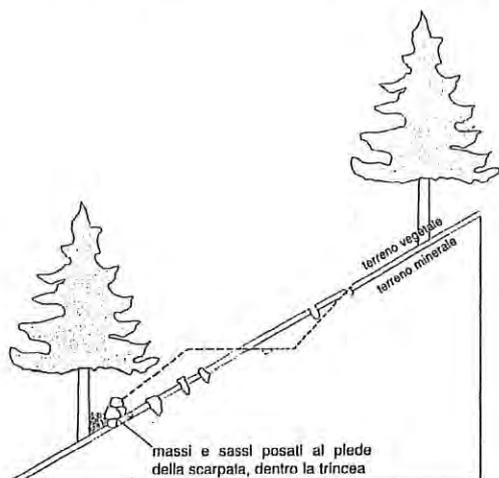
Posizionamento di massi e pietre al piede del rilevato per la formazione del muro d'unghia⁶
